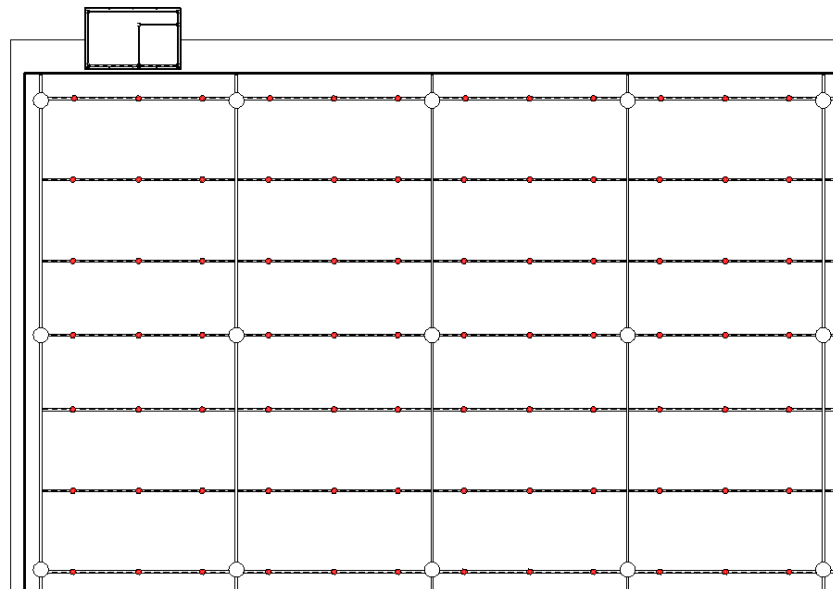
Detalle de la distribución de las luminarias de la planta superior.
